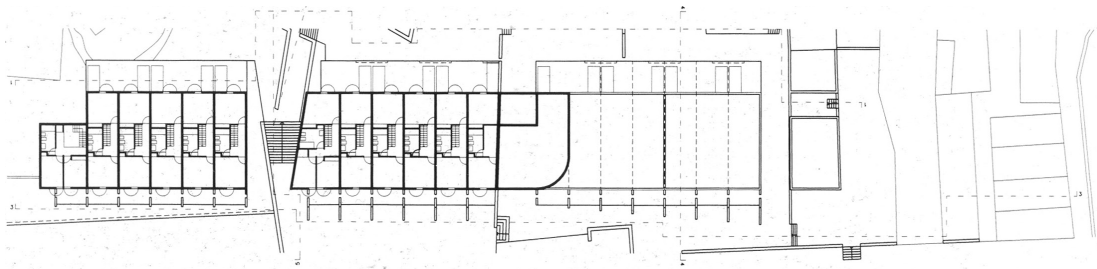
Planta do primeiro piso e planta térrea do edifício A1, Sra. das Dores.
